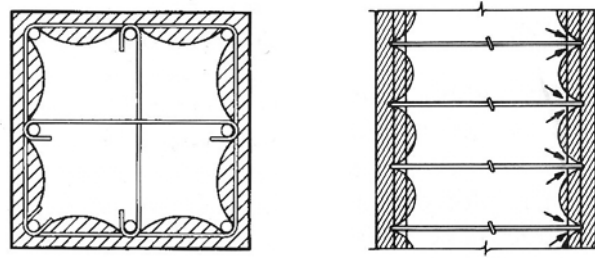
Sezione orizzontale e verticale di un pilastro in cemento armato.
